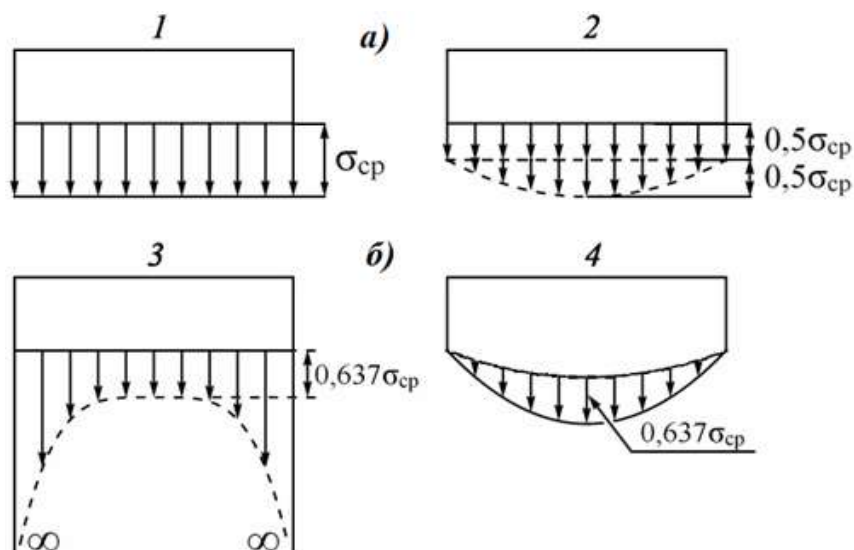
Эпюры давлений по подошве ленточных фундаментав.
